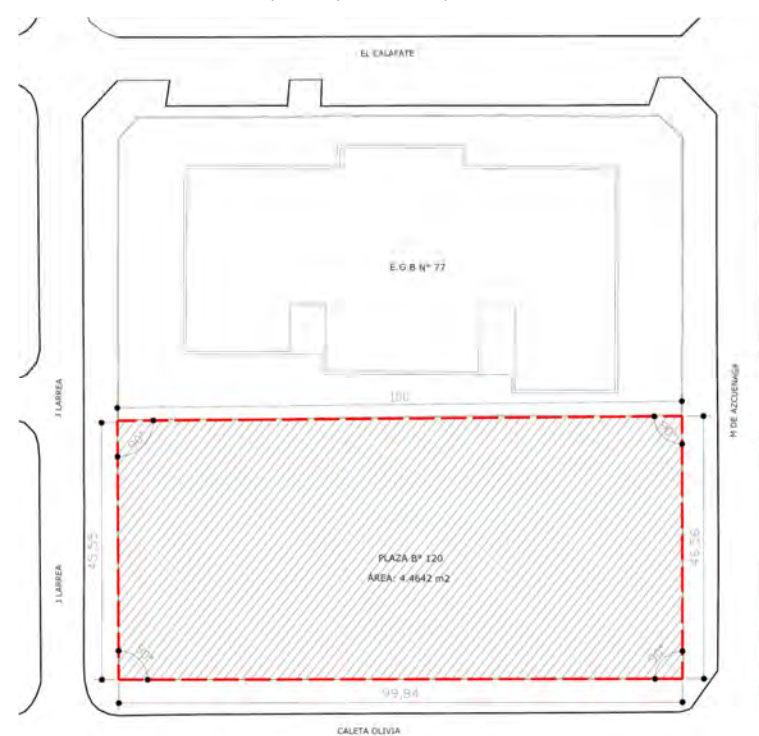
Planta de situación actual predio para nueva plaza en manzana n°242
